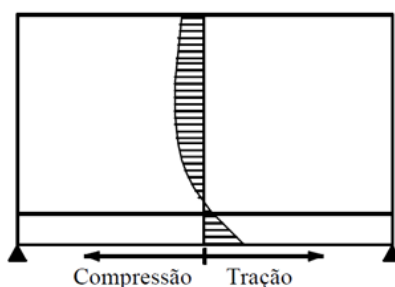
Tensões verticais de tração na interface parede-viga. Fonte: Barbosa (2000).
